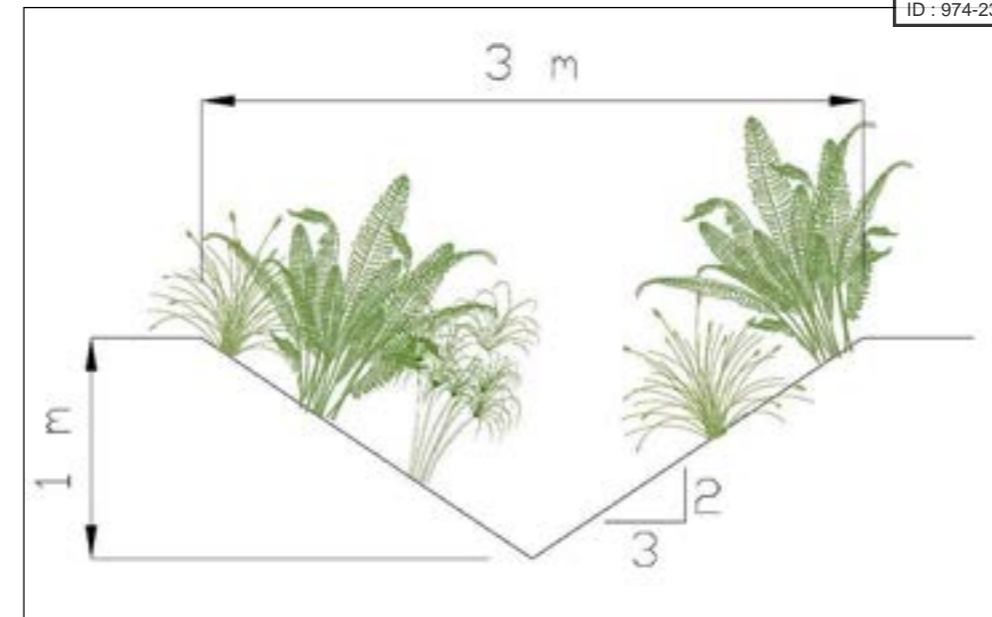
Coupe-type alternative de la noue recueillant les eaux de ruissellement pluvial
